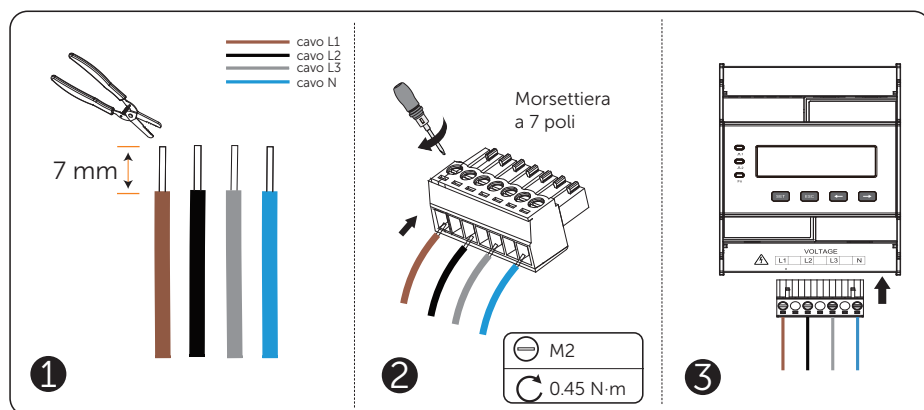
Collegamento del cavo di alimentazione per PSI-X-3SMETER-TAD
